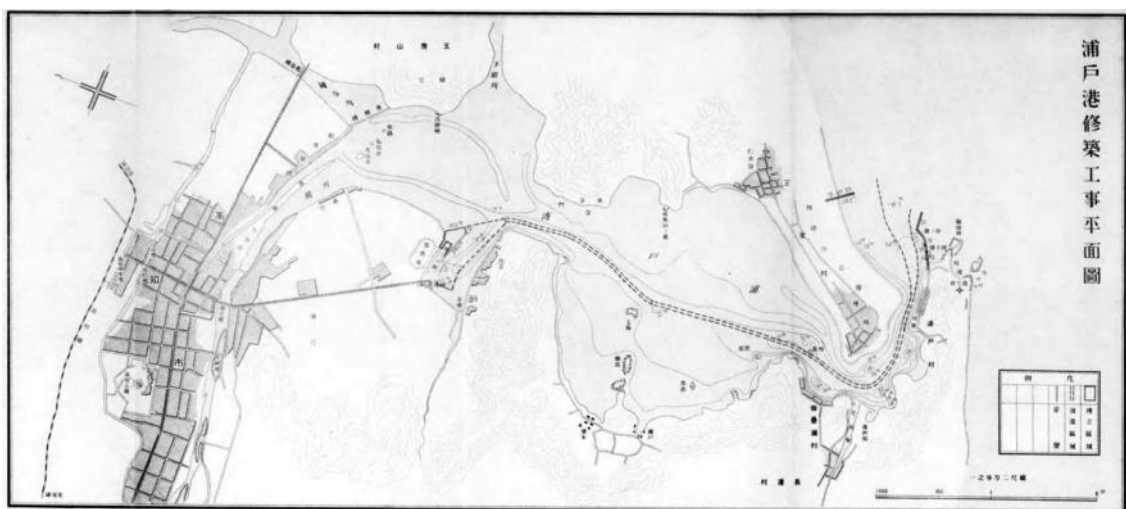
1929年（昭和4年）時点の浦戸港修築工事平面図 [251]
